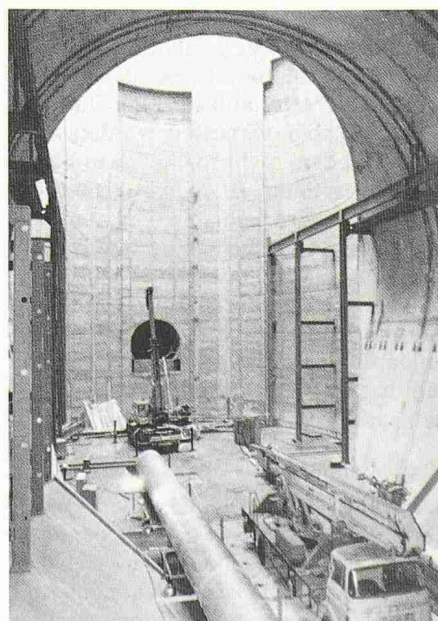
Unterirdische Experimentierhalle für das L3-Experiment mit Hauptschacht. Im Hintergrund erkennt man den LEP-Tunnel
